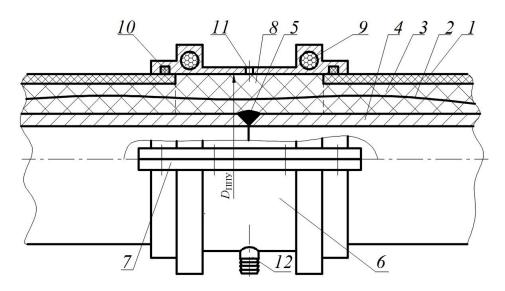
Обогреваемая съемная опалубка для формирования пенополиуретановой теплоизоляции: 1 – оболочка полиэтиленовая; 2 – провод СОДК; 3 –ППУ трубы; 4 – труба стальная; 5 – шов сварной; 6 – обогреваемая съемная опалубка; 7 – фланцевый разъем; 8 – ППУ стыка; 9 – нагреватель; 10 – уплотнение; 11 – дренажное отверстие; 12 – патрубок подачи реакционной смеси
